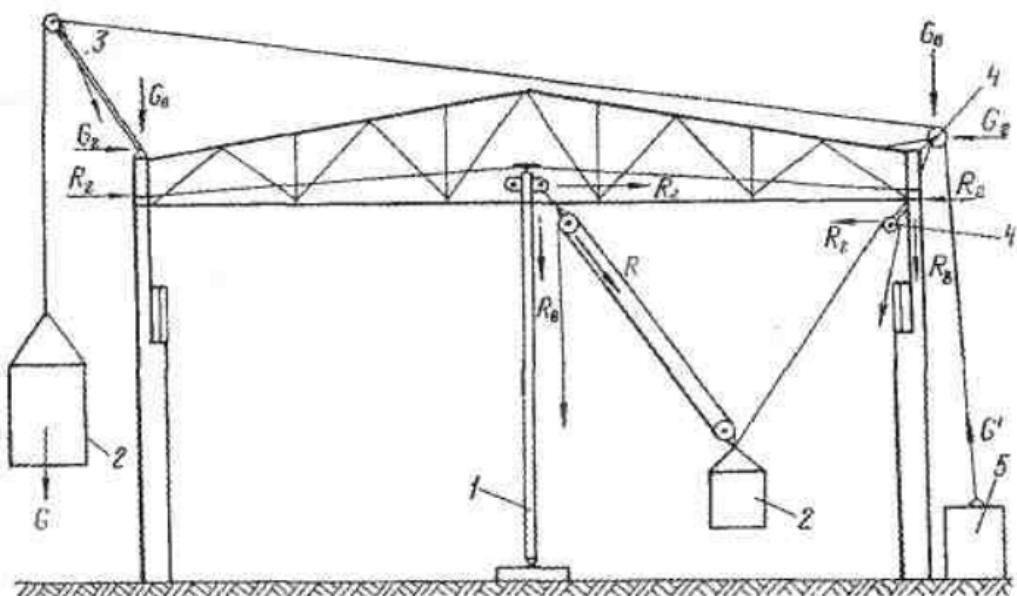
Схема приложения монтажной нагрузки к конструкциям здания:
